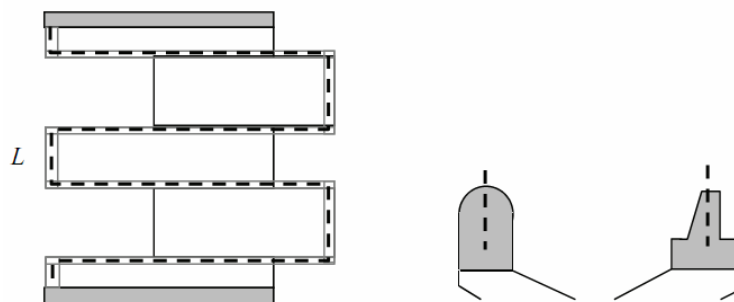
Vue en plan du paramètre L sur une PK-Weir (à gauche)
